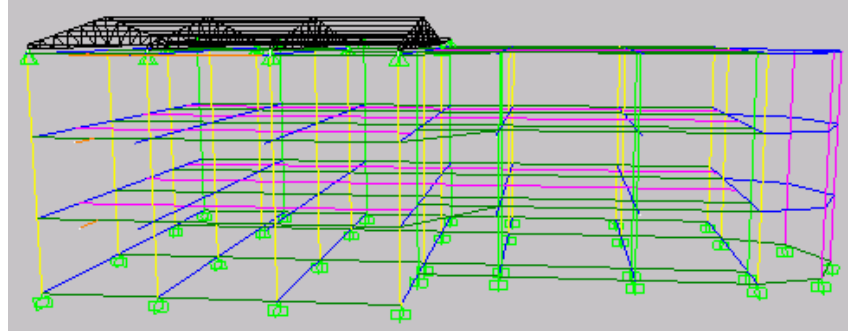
Vista general en planta y lateral del bloque uno modelado con secciones
